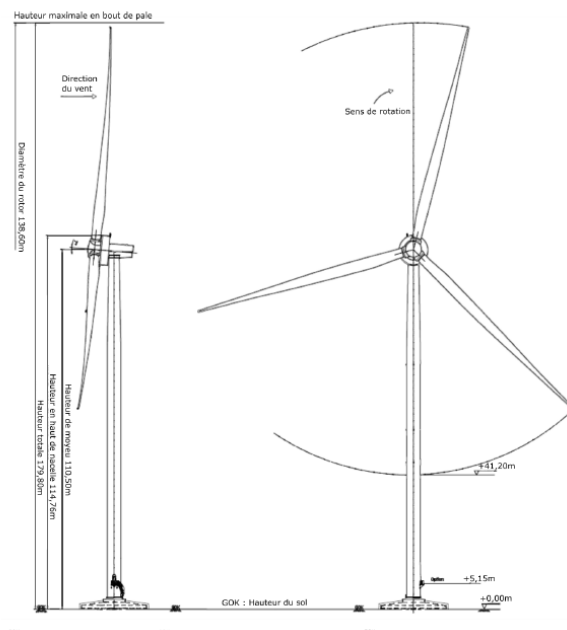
plan d'élevation de l'éolienne ENERCON E-138-EP3
